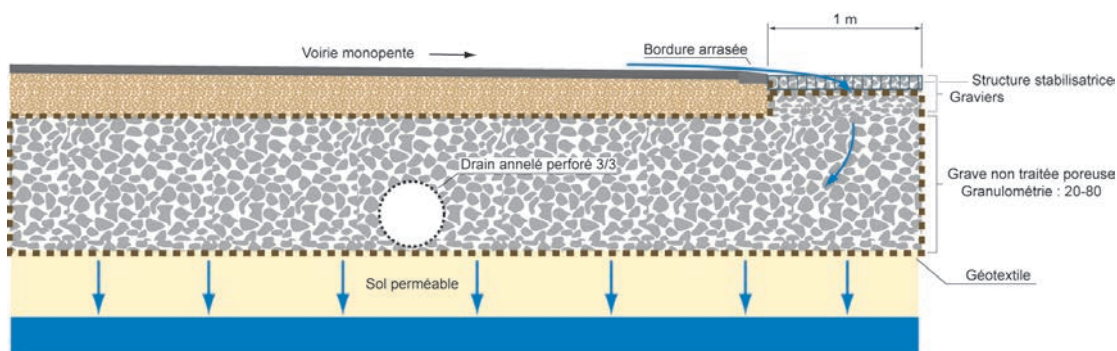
Coupe en travers voirie en mono-pente & rive drainante.
